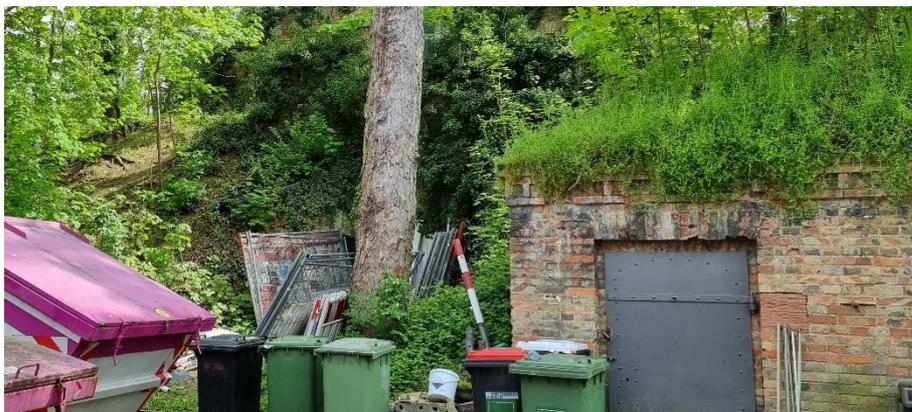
Lagerung von Absperrelemente im Wurzelbereich von Bäumen im GLB
